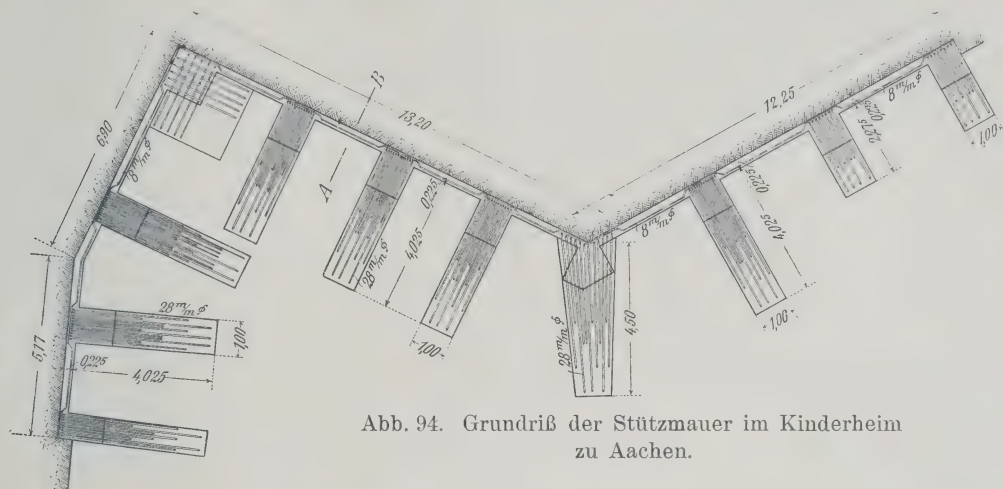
Grundriß der Stützmauer im Kinderheim zu Aachen.
